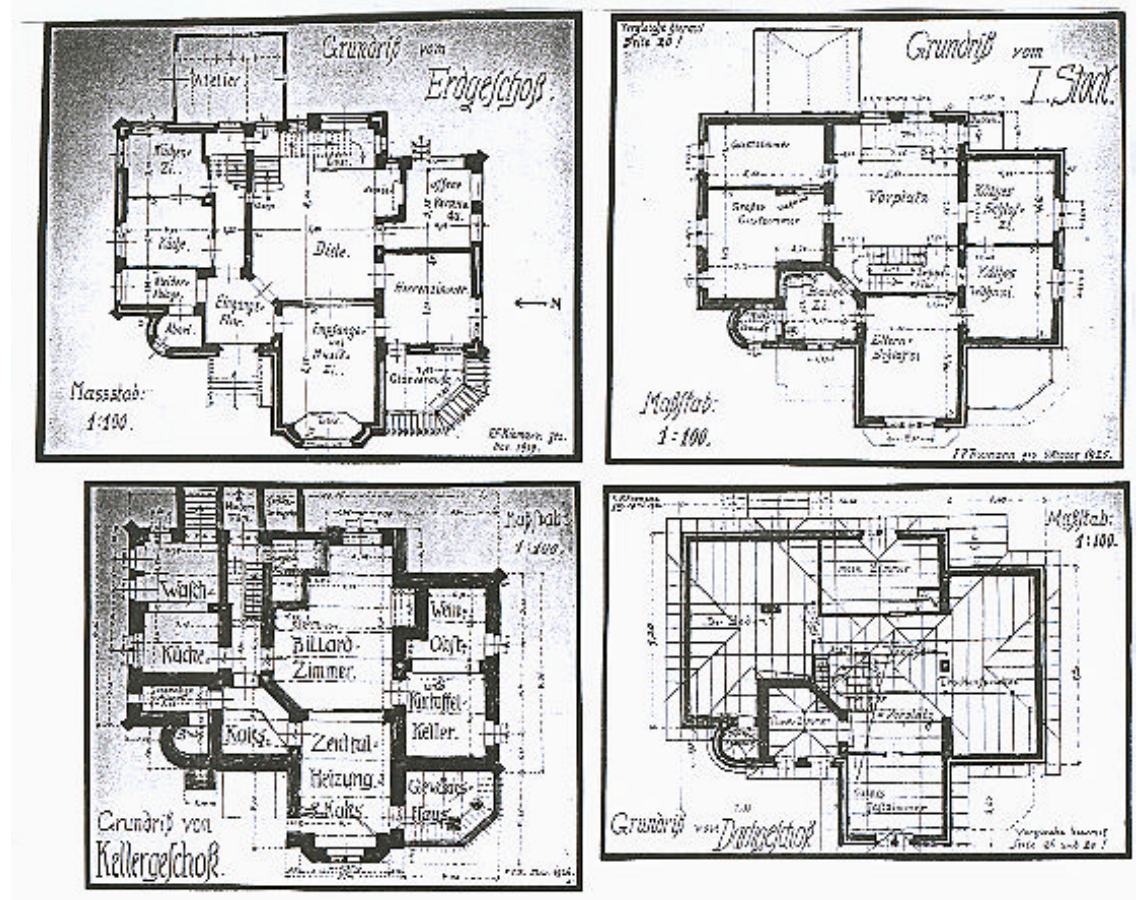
Grundrisse des Hauses Herthastraße 2
